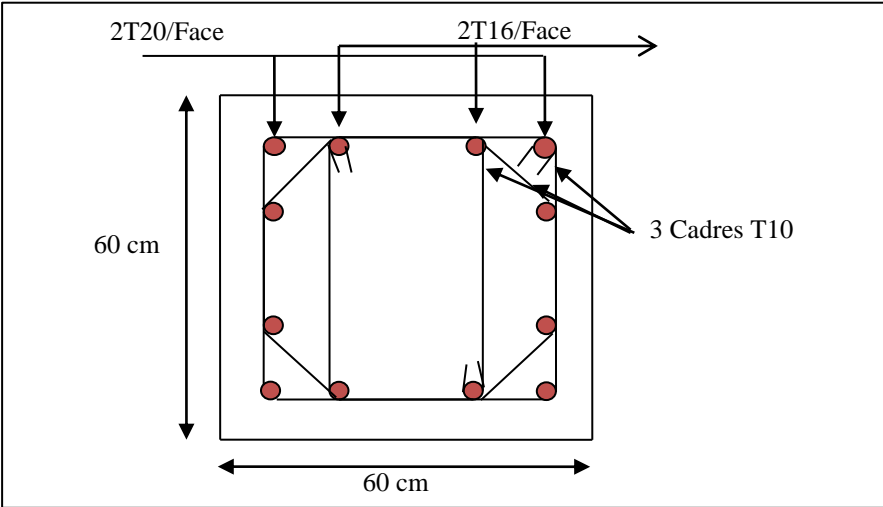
Schéma de ferrailage des poteaux de 1, 2,3 étages.
